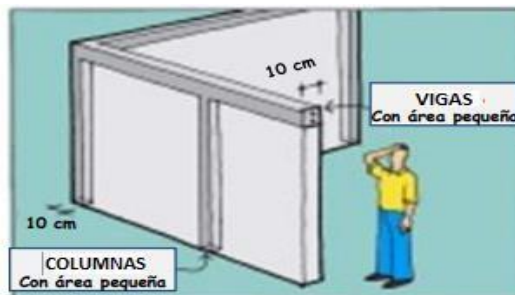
Detalles columna y viga - V. Alta (AIS, 2001)
